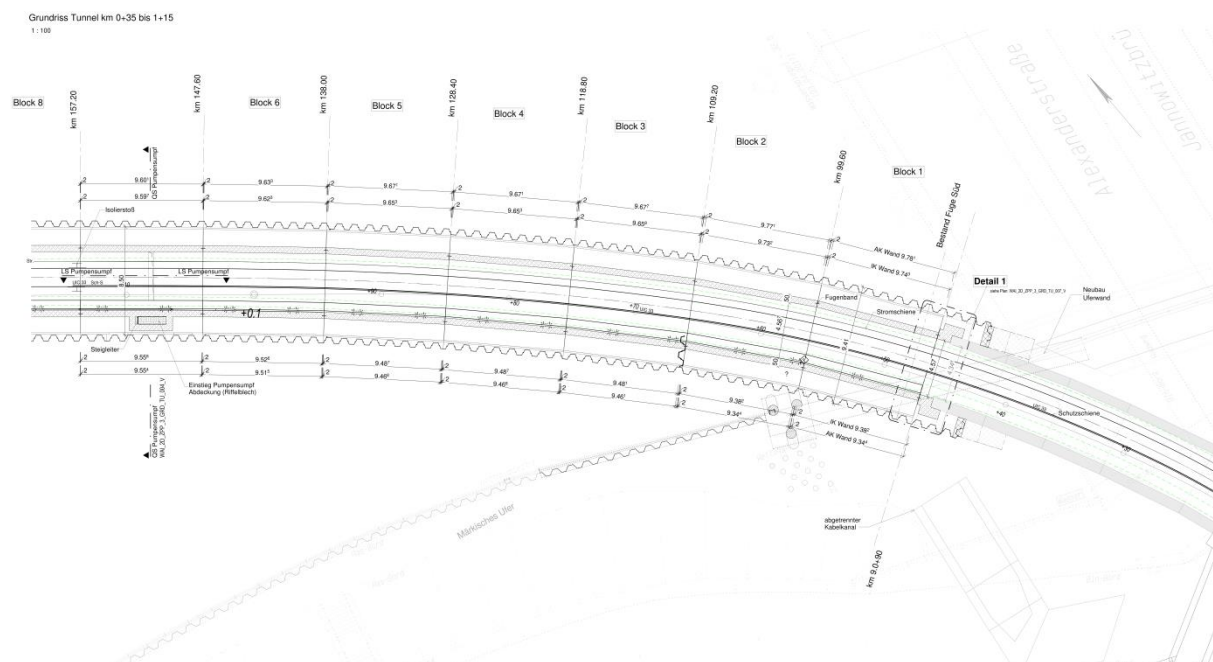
Grundriss Ersatzneubau km 0+35 bis 1+15
